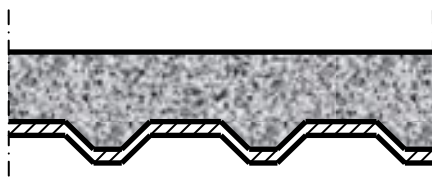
Поперечний переріз сталезалізобетонної плити по сталевому профільованому настилу
